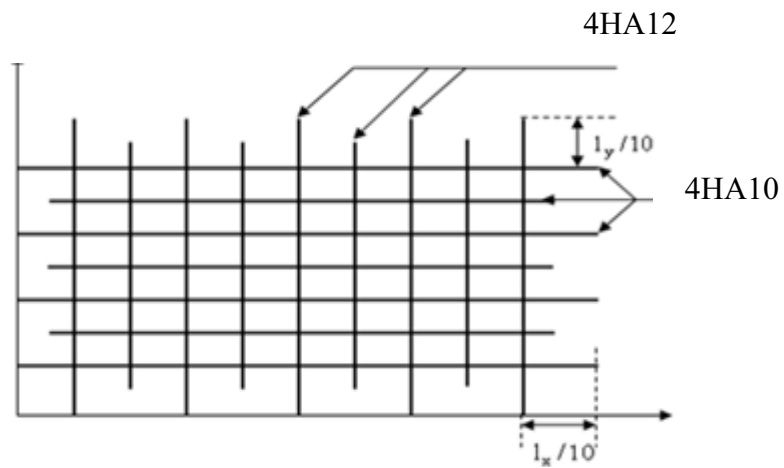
schéma de ferrailage de la dalle d'ascenseur
